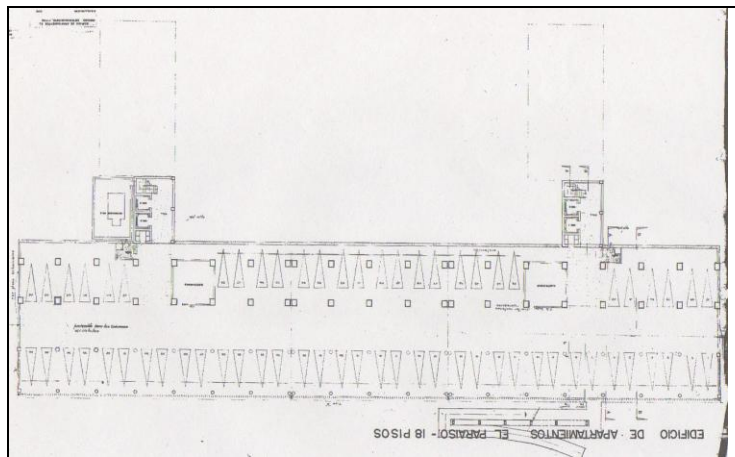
k. Superbloque El Paraíso. Planta 1er Piso. Estacionamiento
